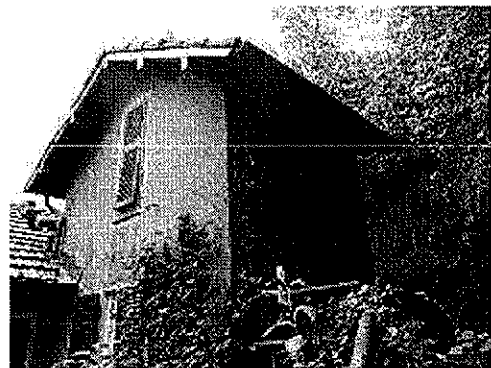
10 – 11 – 12 – 13: Viste dei fronti (foto 9: scala esterna di accesso al piano sottotetto)
